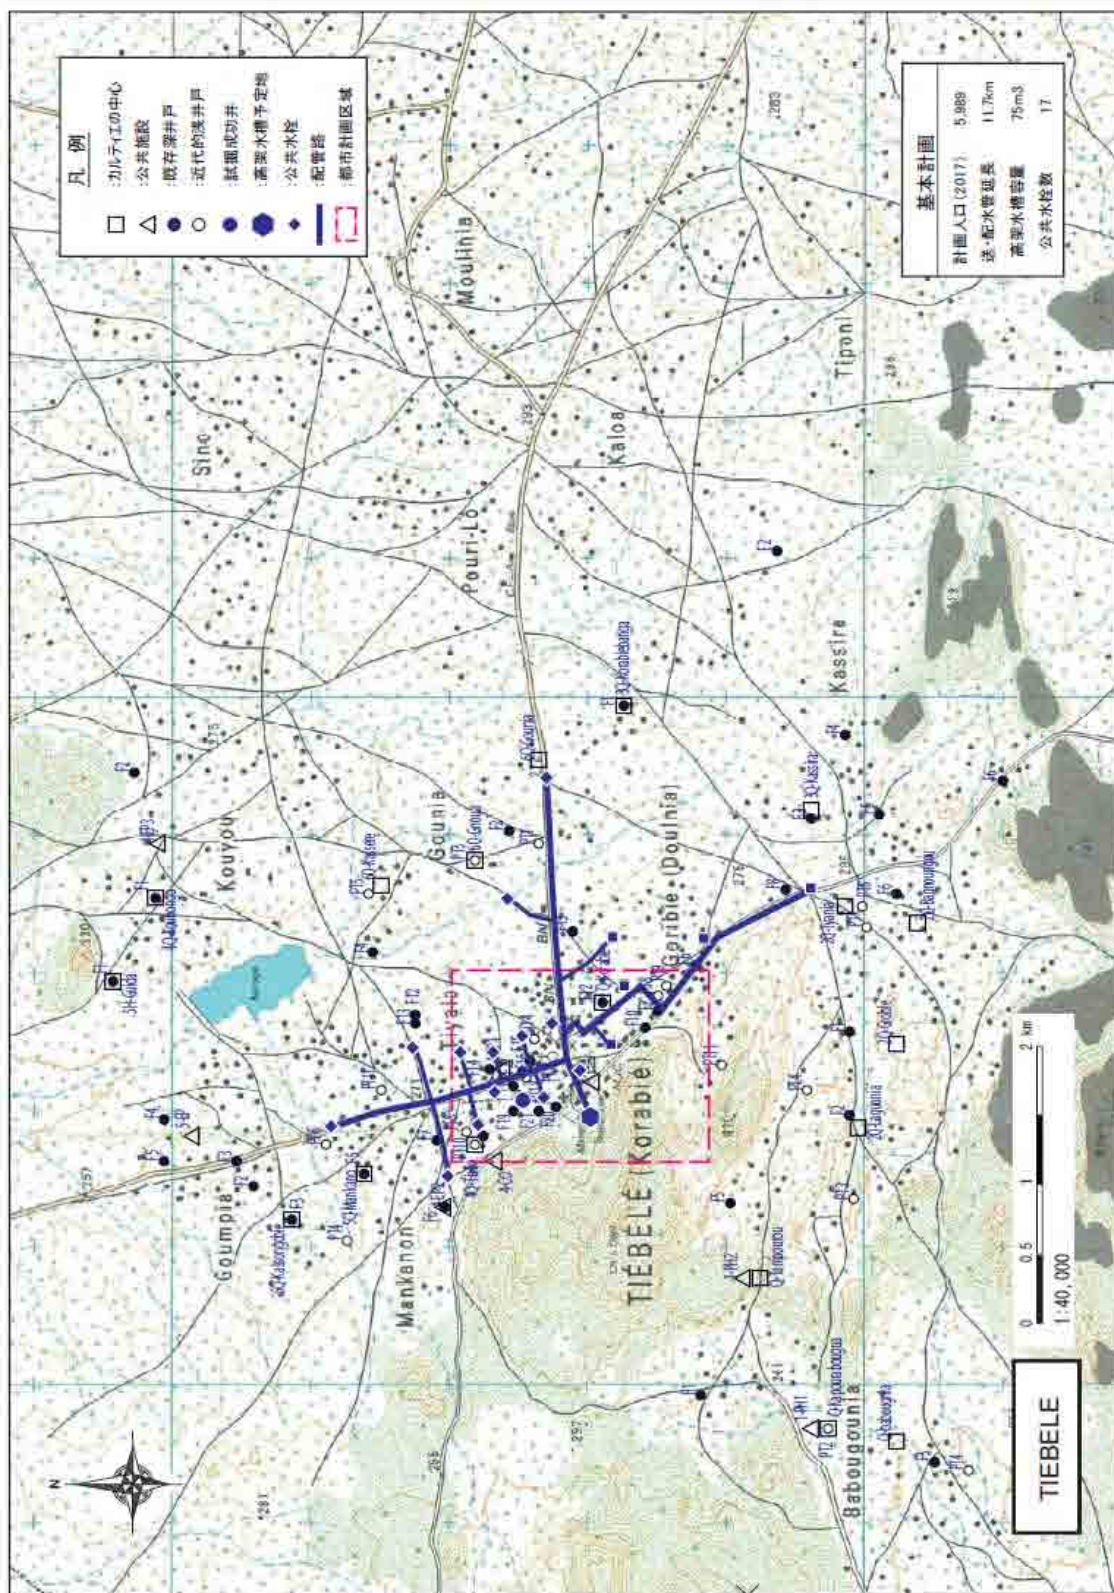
計画対象サイト(Tiébélé)の給水施設広域平面図
